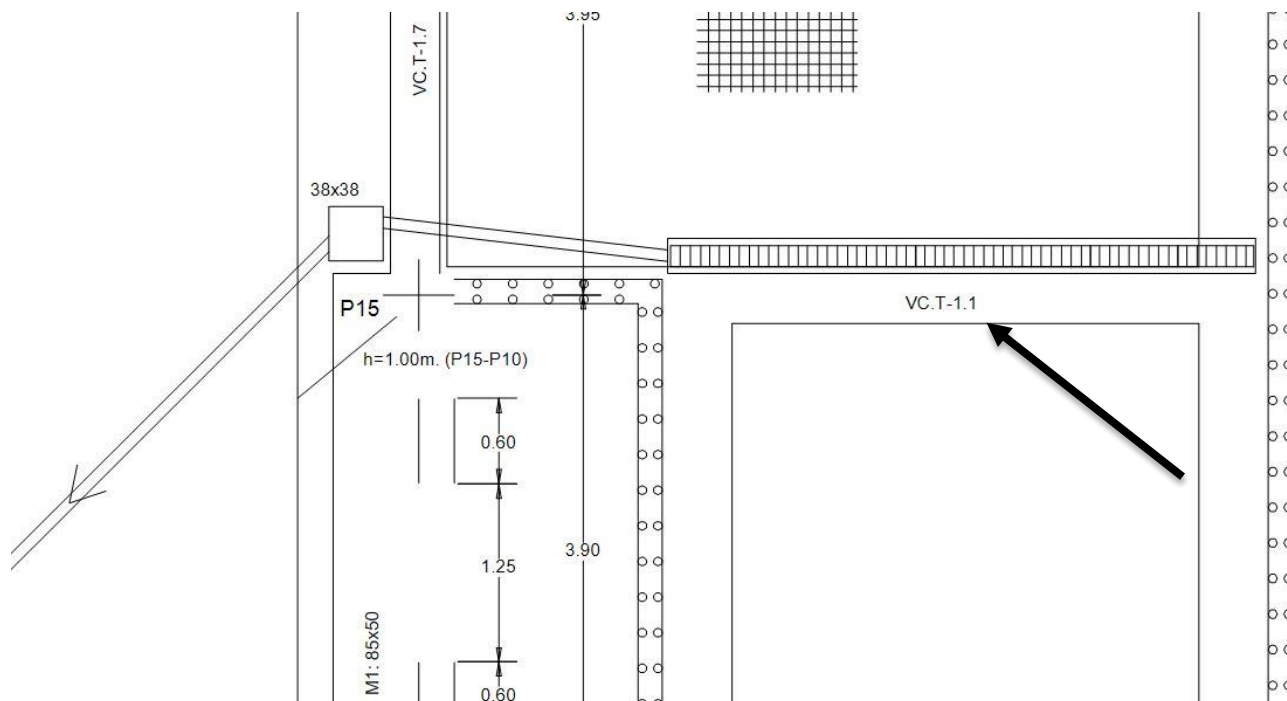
Selección del plano donde aparece la viga VC.T-1.1 no contemplada en el cuadro de vigas.
